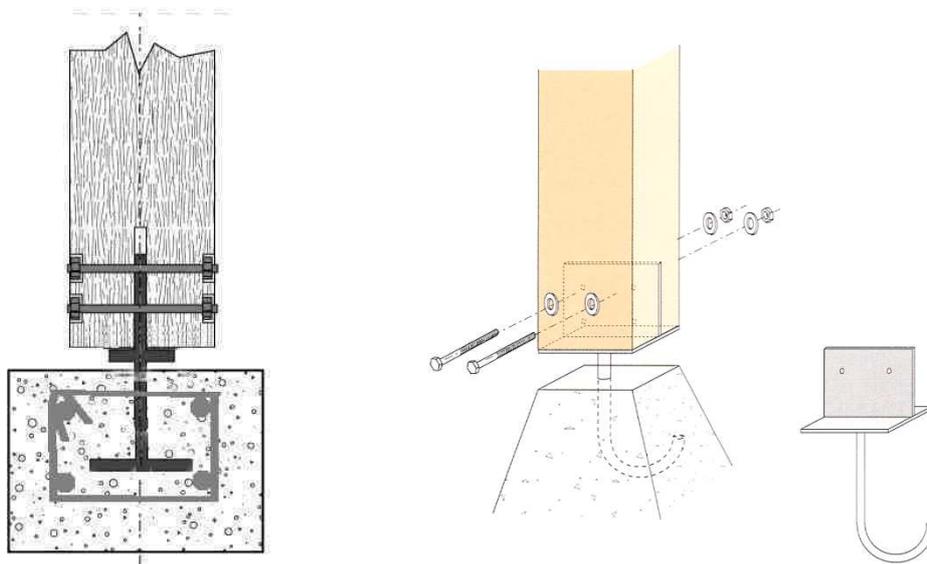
Schémas de principe d'ancrage en pied de poteau charpentes d'auvent et de toiture sur terrasse
